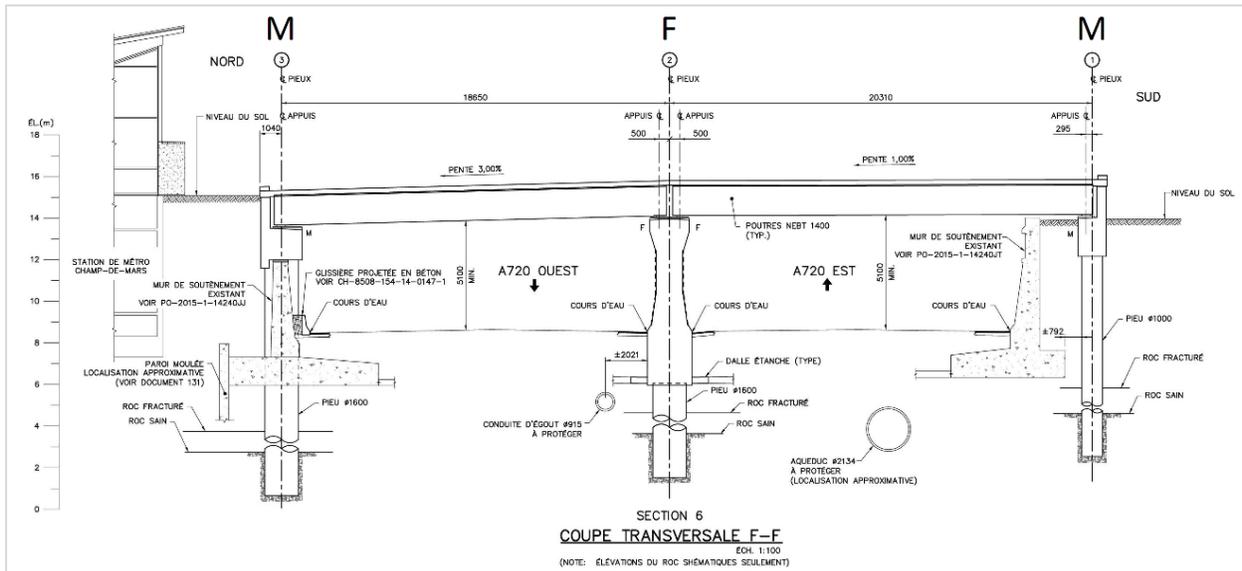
Système statique de la structure de recouvrement. Mobiles (M) aux culées et fixe (F) à la pile centrale
